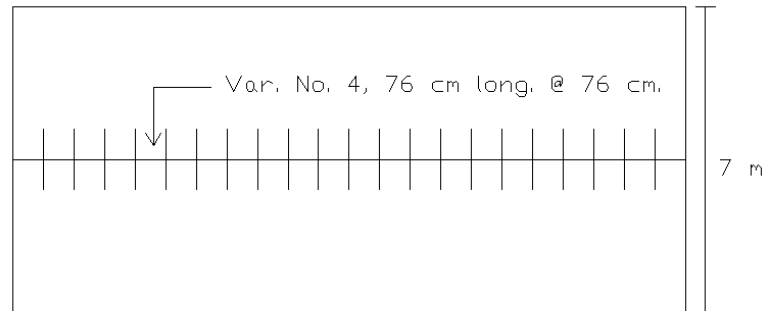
Juntas longitudinales para diseño de pavimento rígido.
